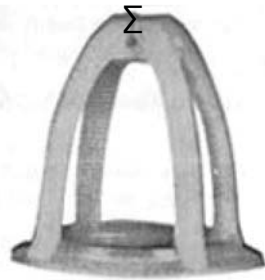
TAMAÑOS TÍPICOS Y DIMENSIONES DE SOPORTES FABRICADOS TOTALMENTE DE PLÁSTICO PARA VARILLAS. Fuente: Placing Reinforcing Bars, Concrete Reinforcing Steel Institute, 1999; p.95.
